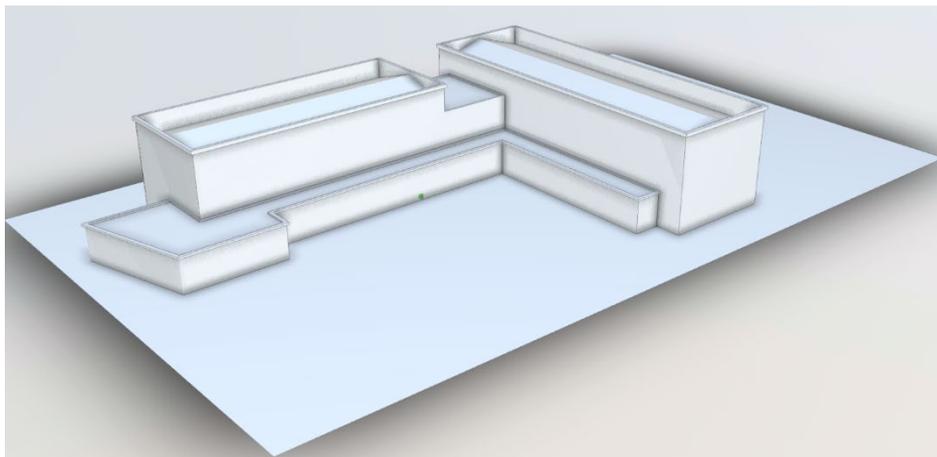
Propuesta de paneles de Alucobond en fachada
